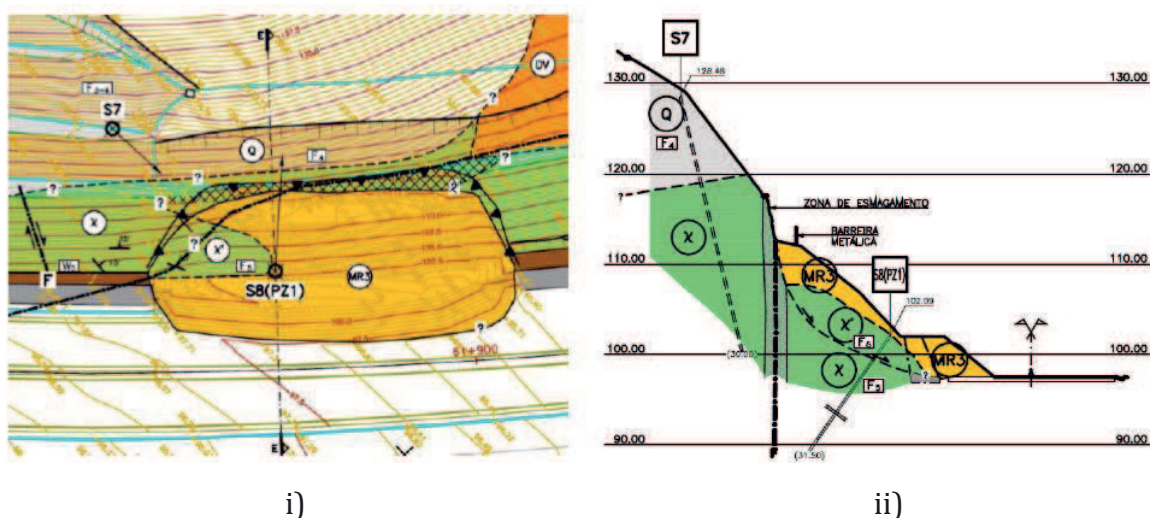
Planta e corte da zona de ocorrência do escorregamento - i) Planta Geológica; ii) Corte geológico (Corte E) (Cenor).
